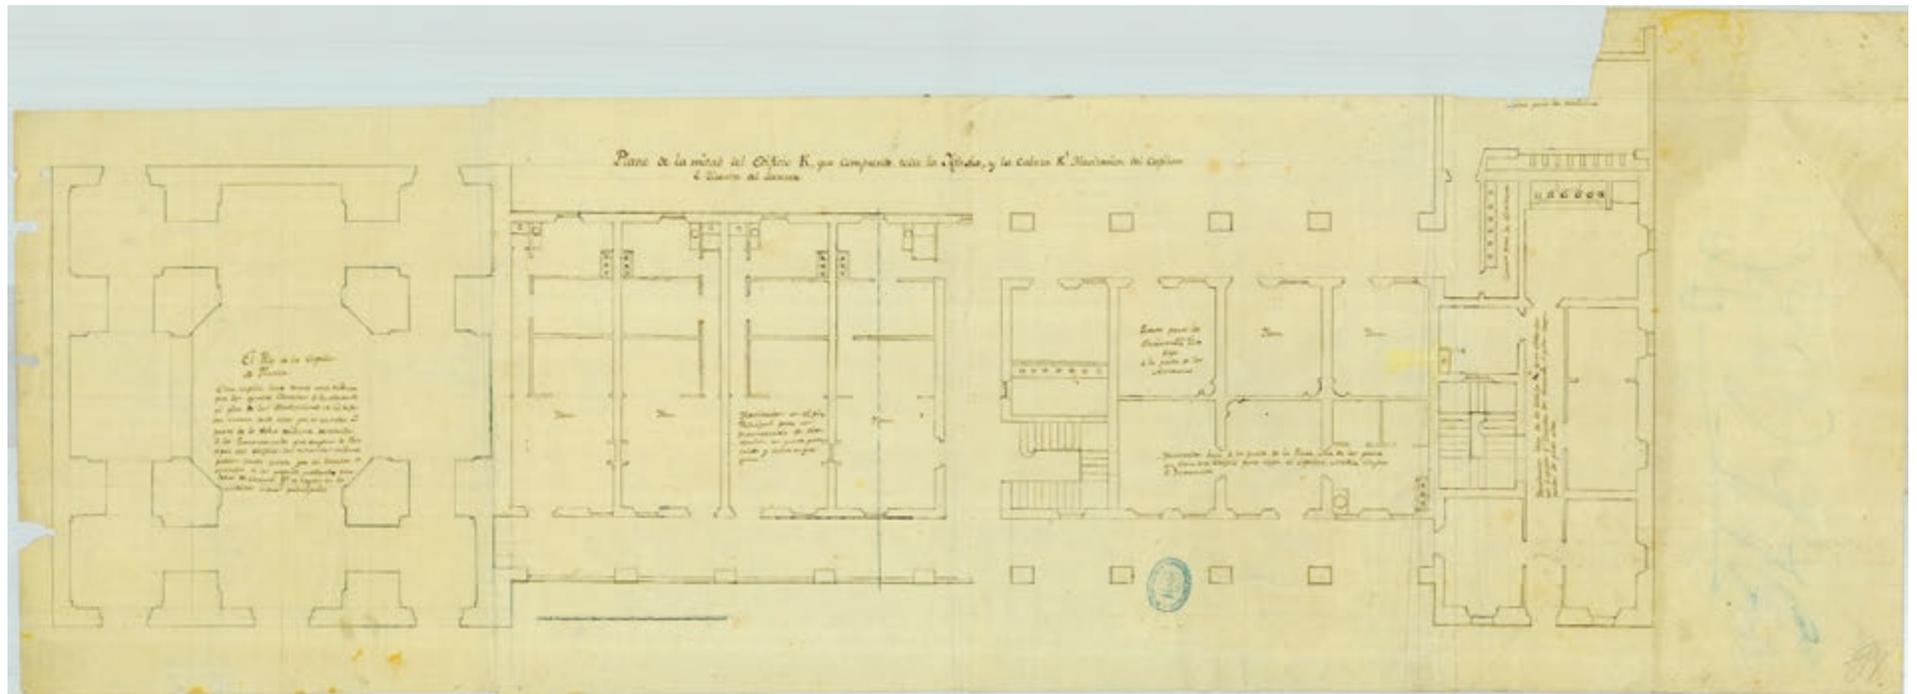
PLANO DEL EDIFICIO DEL LAZARETO. *Planta*. AGMM IB-20/13 e IB-20/14.
